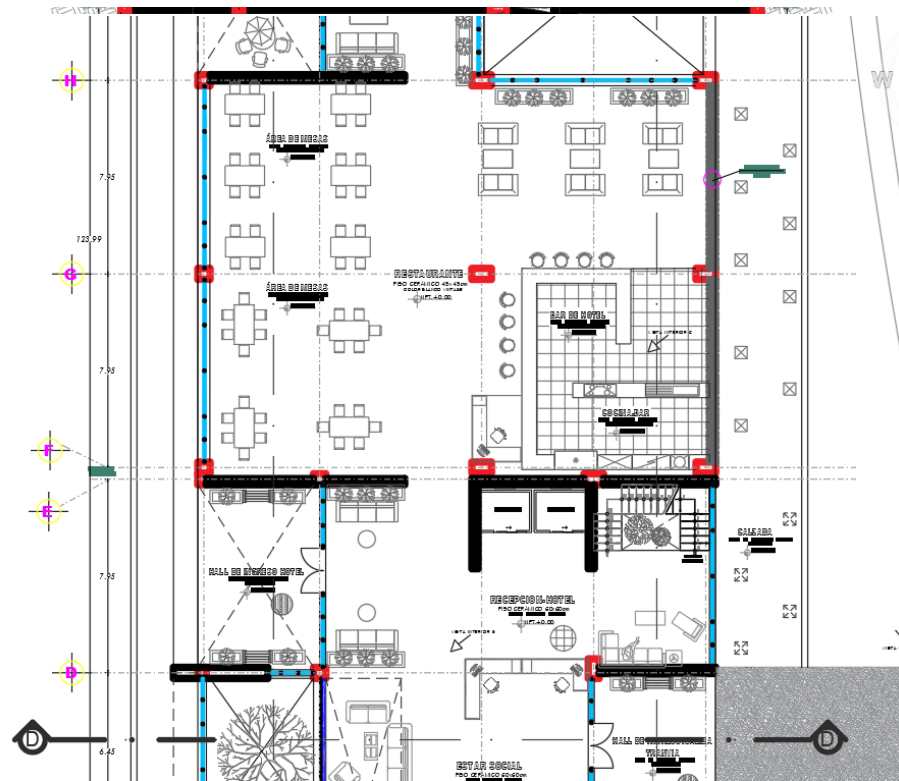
Sección de desarrollo estructural – Primer nivel, zona restaurante.
